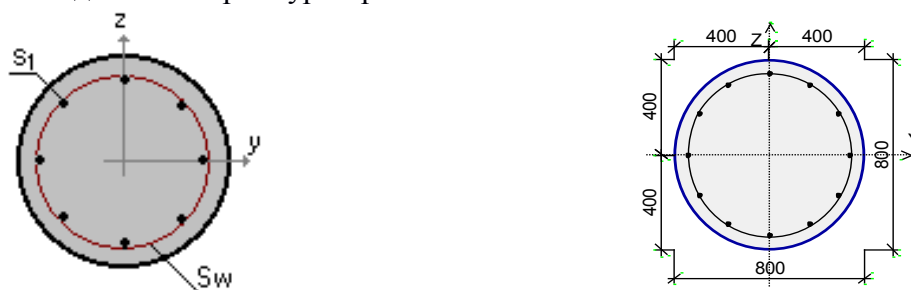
Результати підбору армування для тривимірної схеми: поздовжня арматура S1 – 12Ø22; поперечна арматура SW – Ø12; крок поперечної арматури 150 мм
